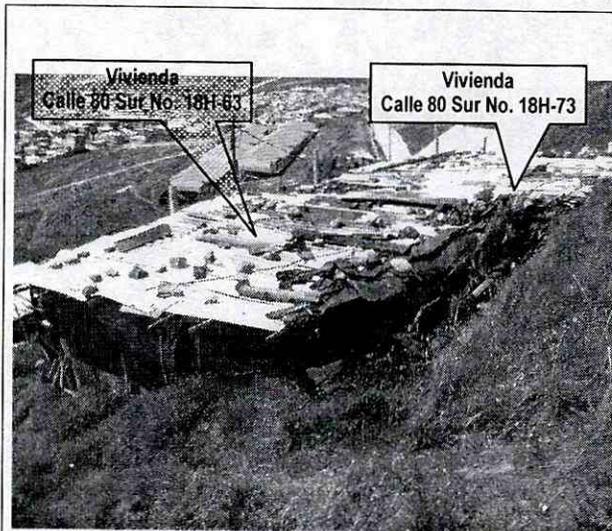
Vista del costado occidental de las viviendas de la Calle 80 Sur No. 18H-63 y de la Calle 80 Sur No. 18H-73.
